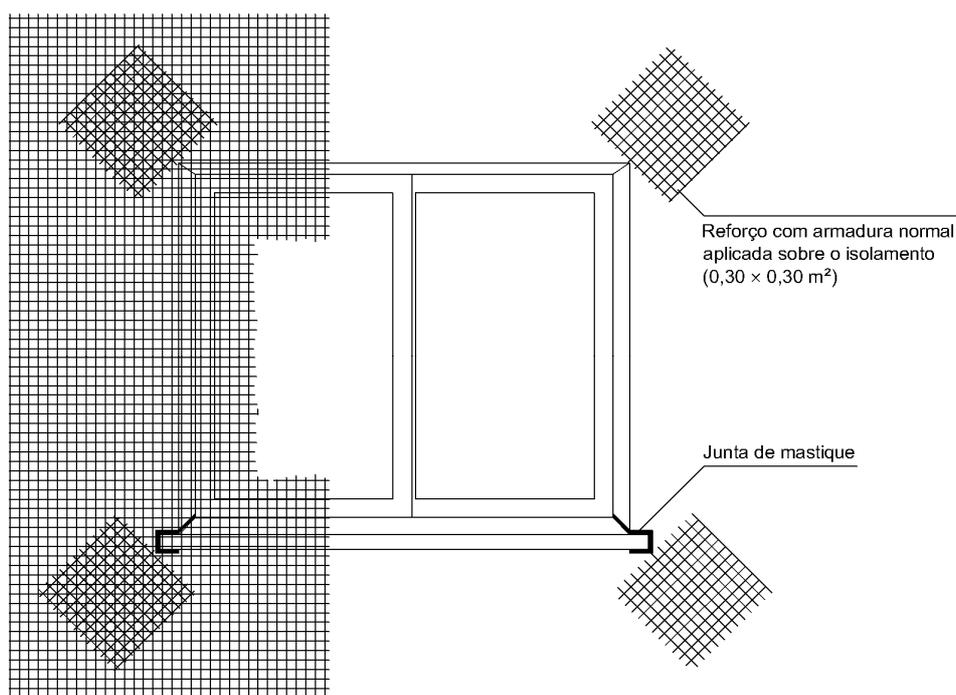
Reforço da armadura no contorno dos vãos da fachada
